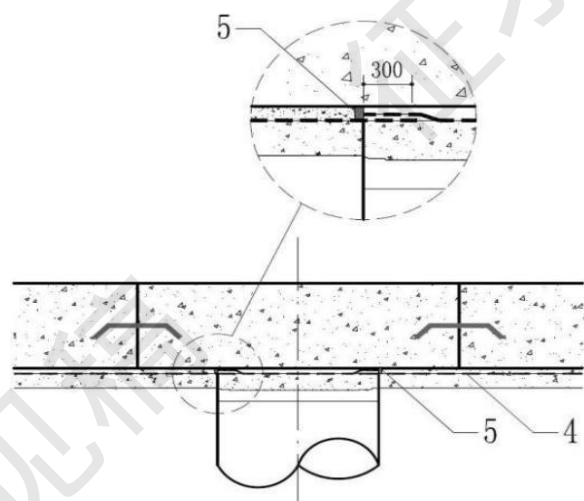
(b) 钢筋混凝土立柱凿除后防水施工示意图
